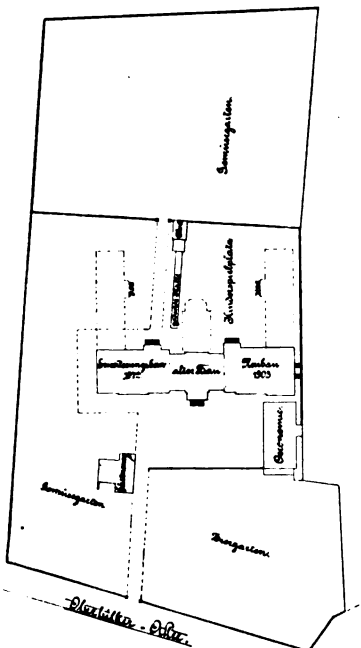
Lageplan des katholischen Knaben-Waisenhauses.
